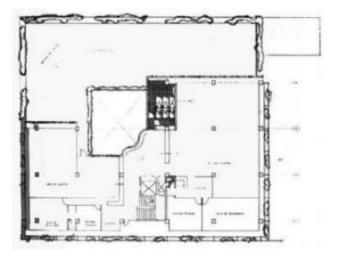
Plano de planta alta tipo, MAG. Fuente: Libro BAQ, (1980)
